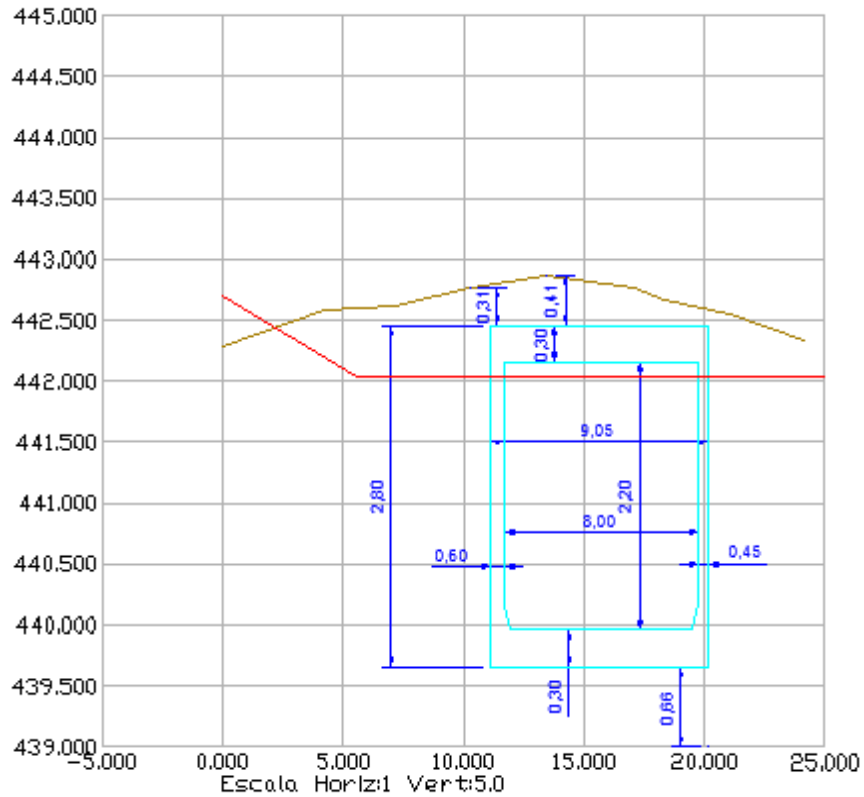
Corte transversal. Edet Av. Guzman.
